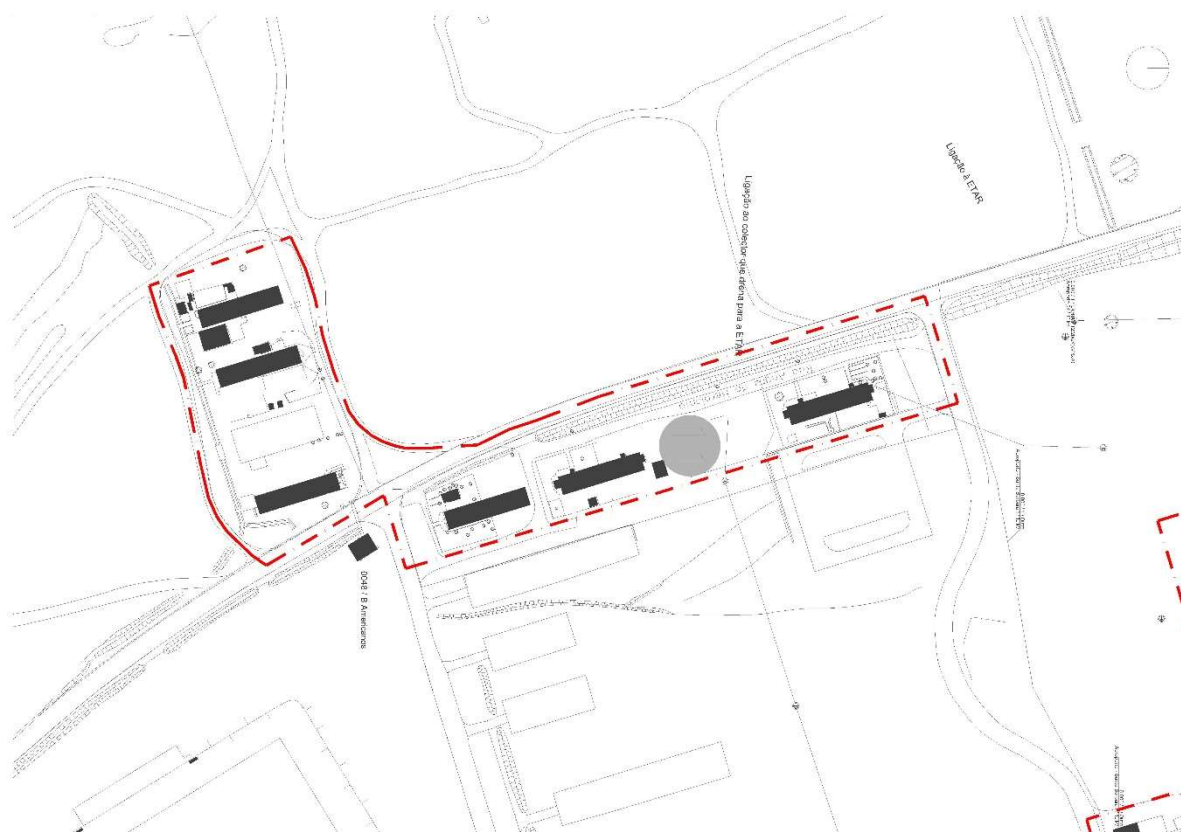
Planta do Bairro dos Americanos (Extrato de Planta Cedida Pelas Ilhas de Valor)
